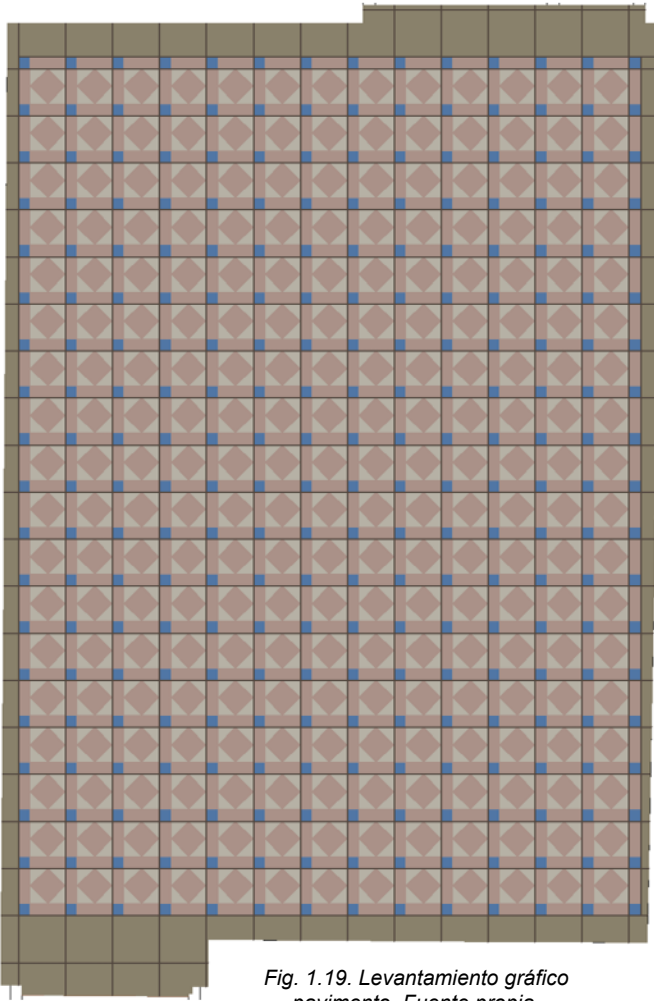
Levantamiento gráfico pavimento. Fuente propia.
